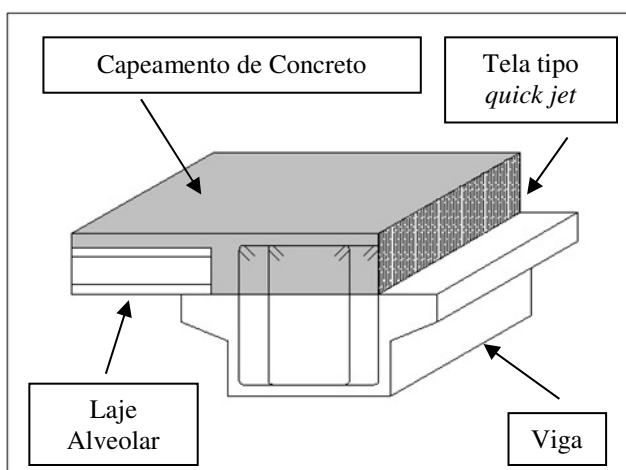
Detalhe da junta de concretagem entre panos de laje contíguas executada com tela galvanizada tipo *quick jet*.
